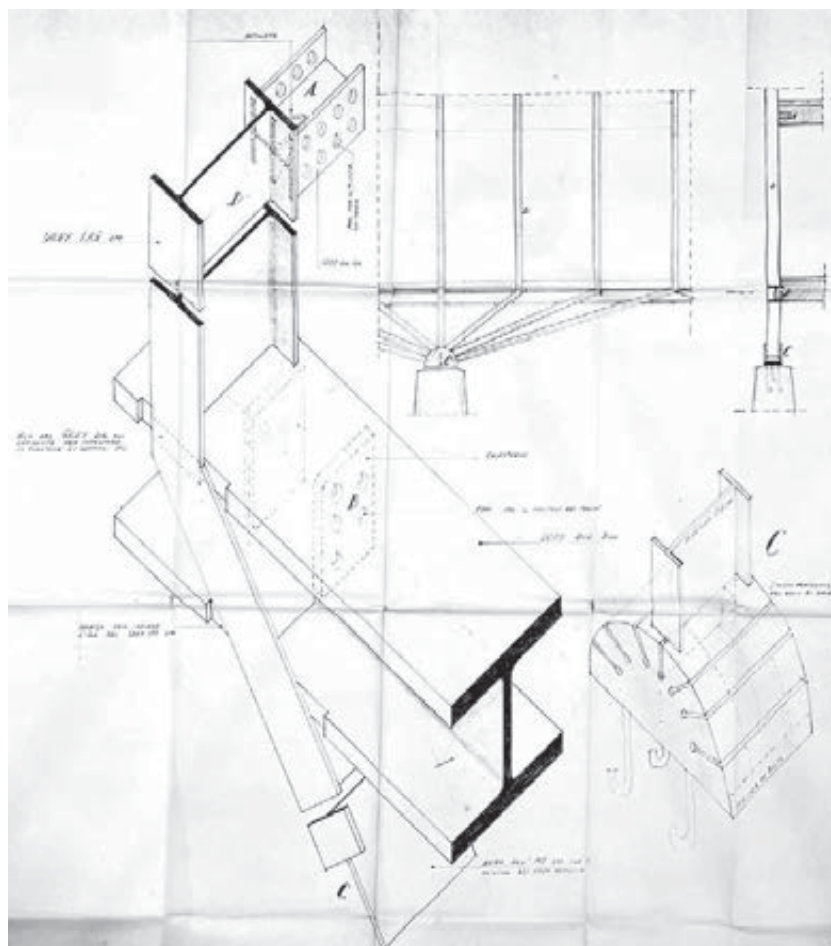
Schema di dettaglio del nodo di acciaio che connette la struttura in elevazione ai pilastri in cemento dei piani basamentali (AI, faldone 2295)
